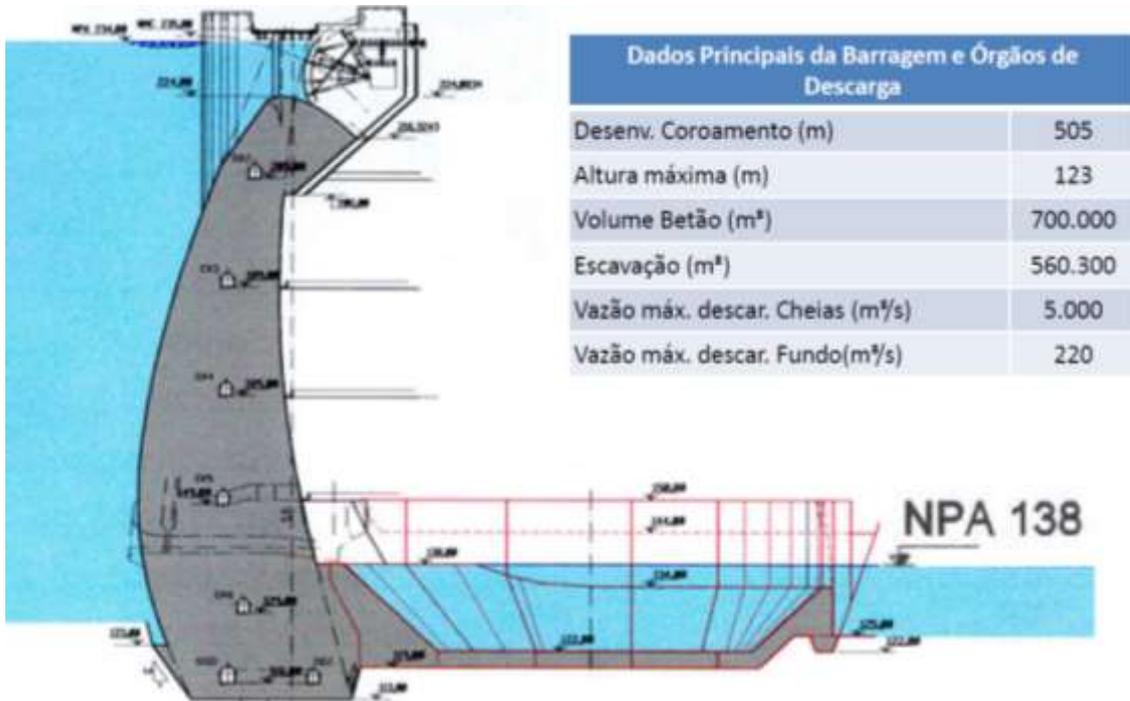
Dados Principais da Barragem e Órgãos de Descarga (6)
